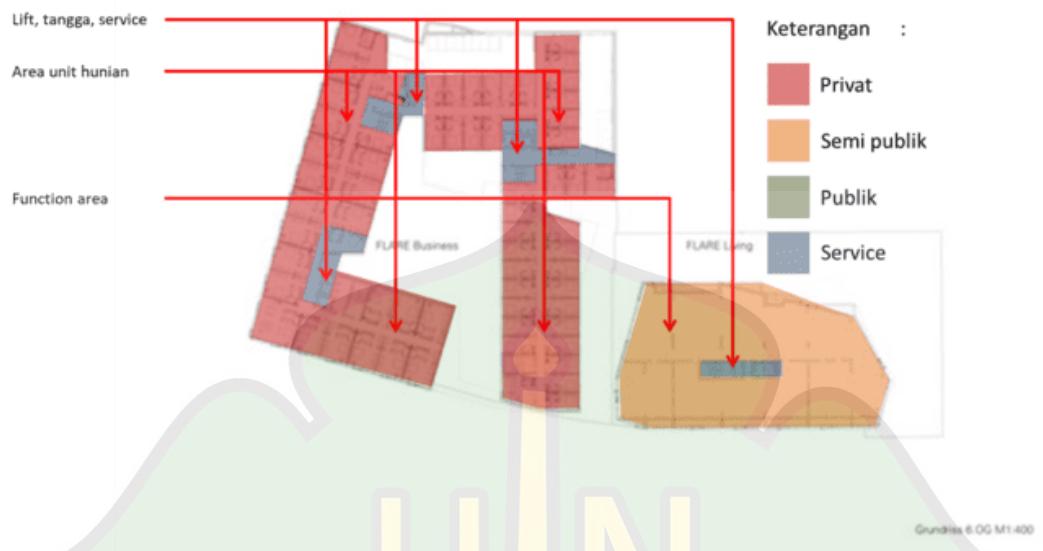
Analisis ruang pada denah lantai kelima Flare of Frankfurt
